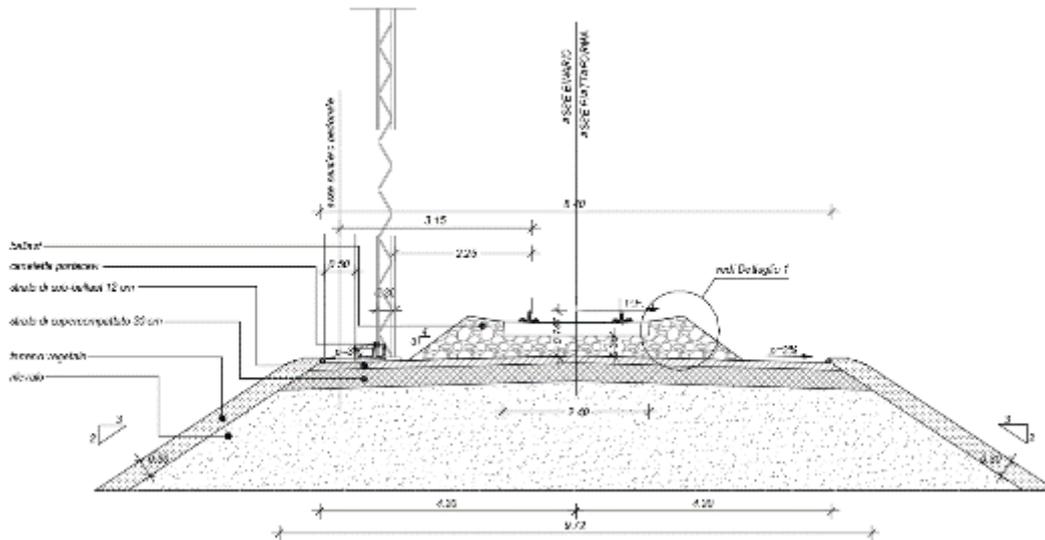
RFI Manuale di Progettazione – Sezione tipo in rilevato per singolo binario
